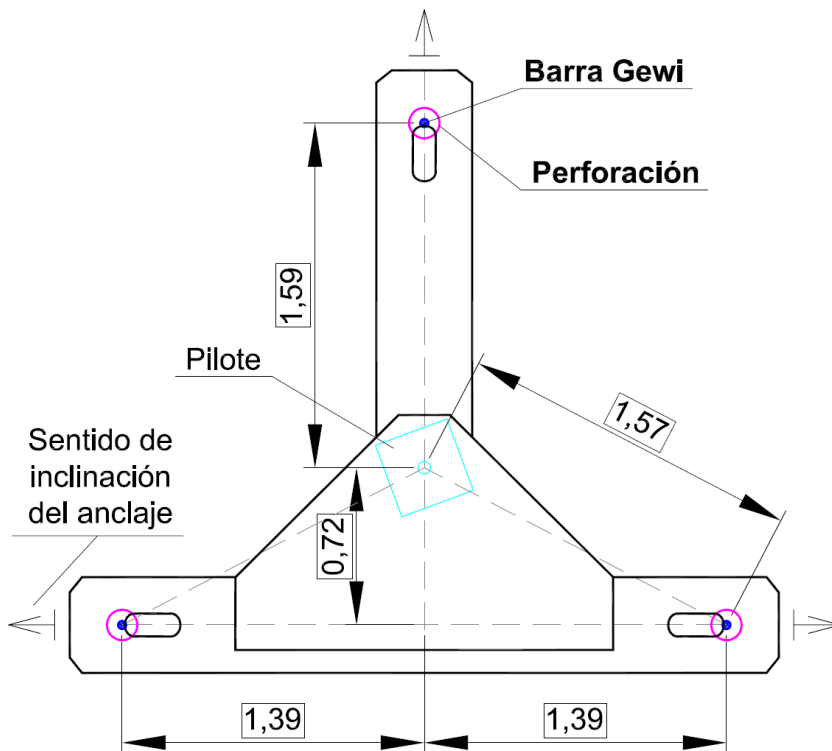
Disposición en planta de los anclajes. Croquis de replanteo
